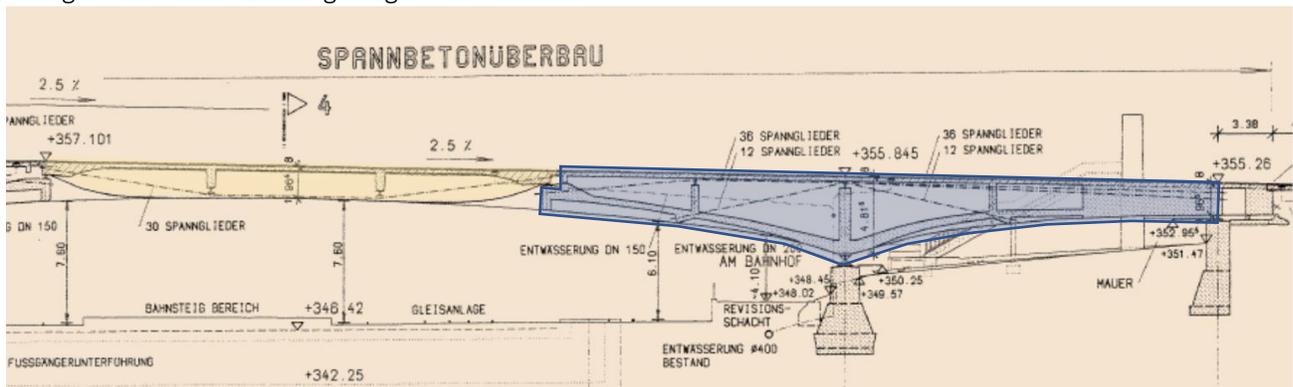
Teilbereich des Spannbetonüberbaus im Schnitt Einhängeträger (gelb unterlegt), rechter Kragträger (blau unterlegt)
